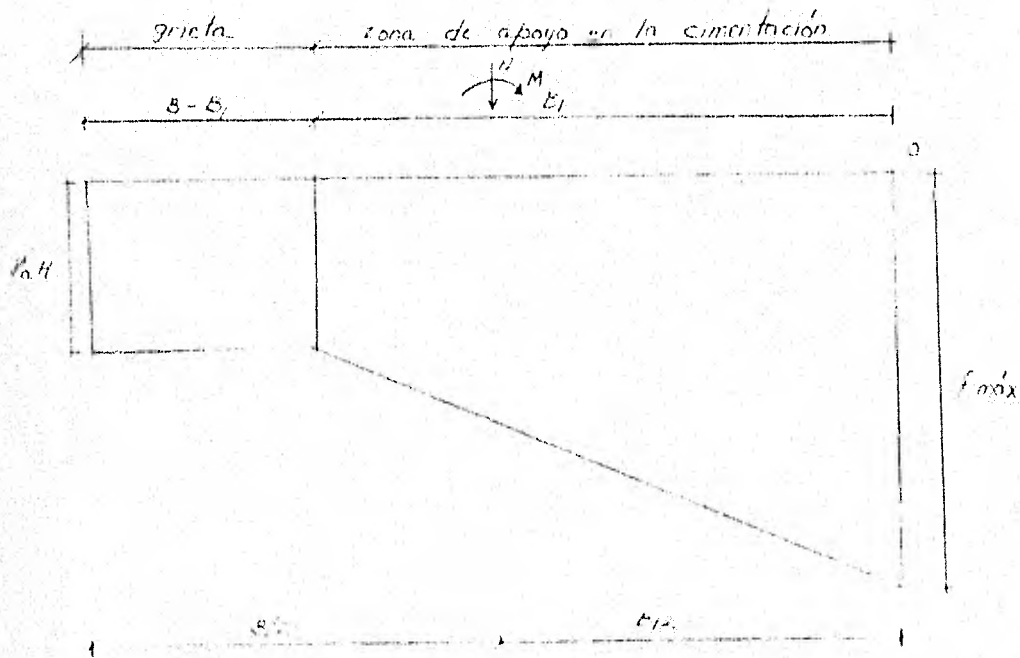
Longitud de la grieta: C_1 en la zona de apoyo en la cimentación de la presa.
